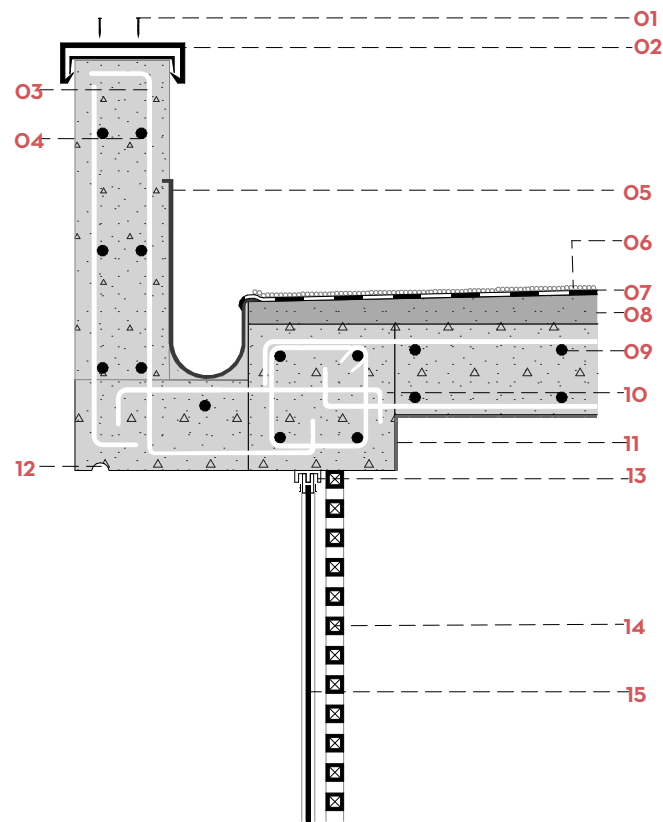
Detalle constructivo O3. Fuente: Autoría propia.
